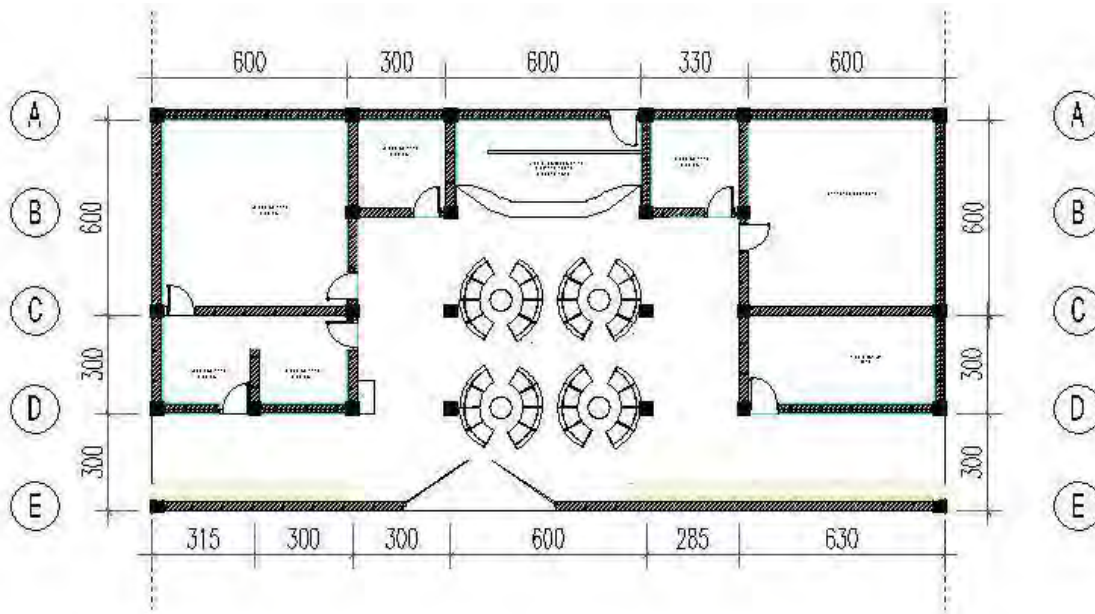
10 Denah Alternatif 1 Ruang Lobby
